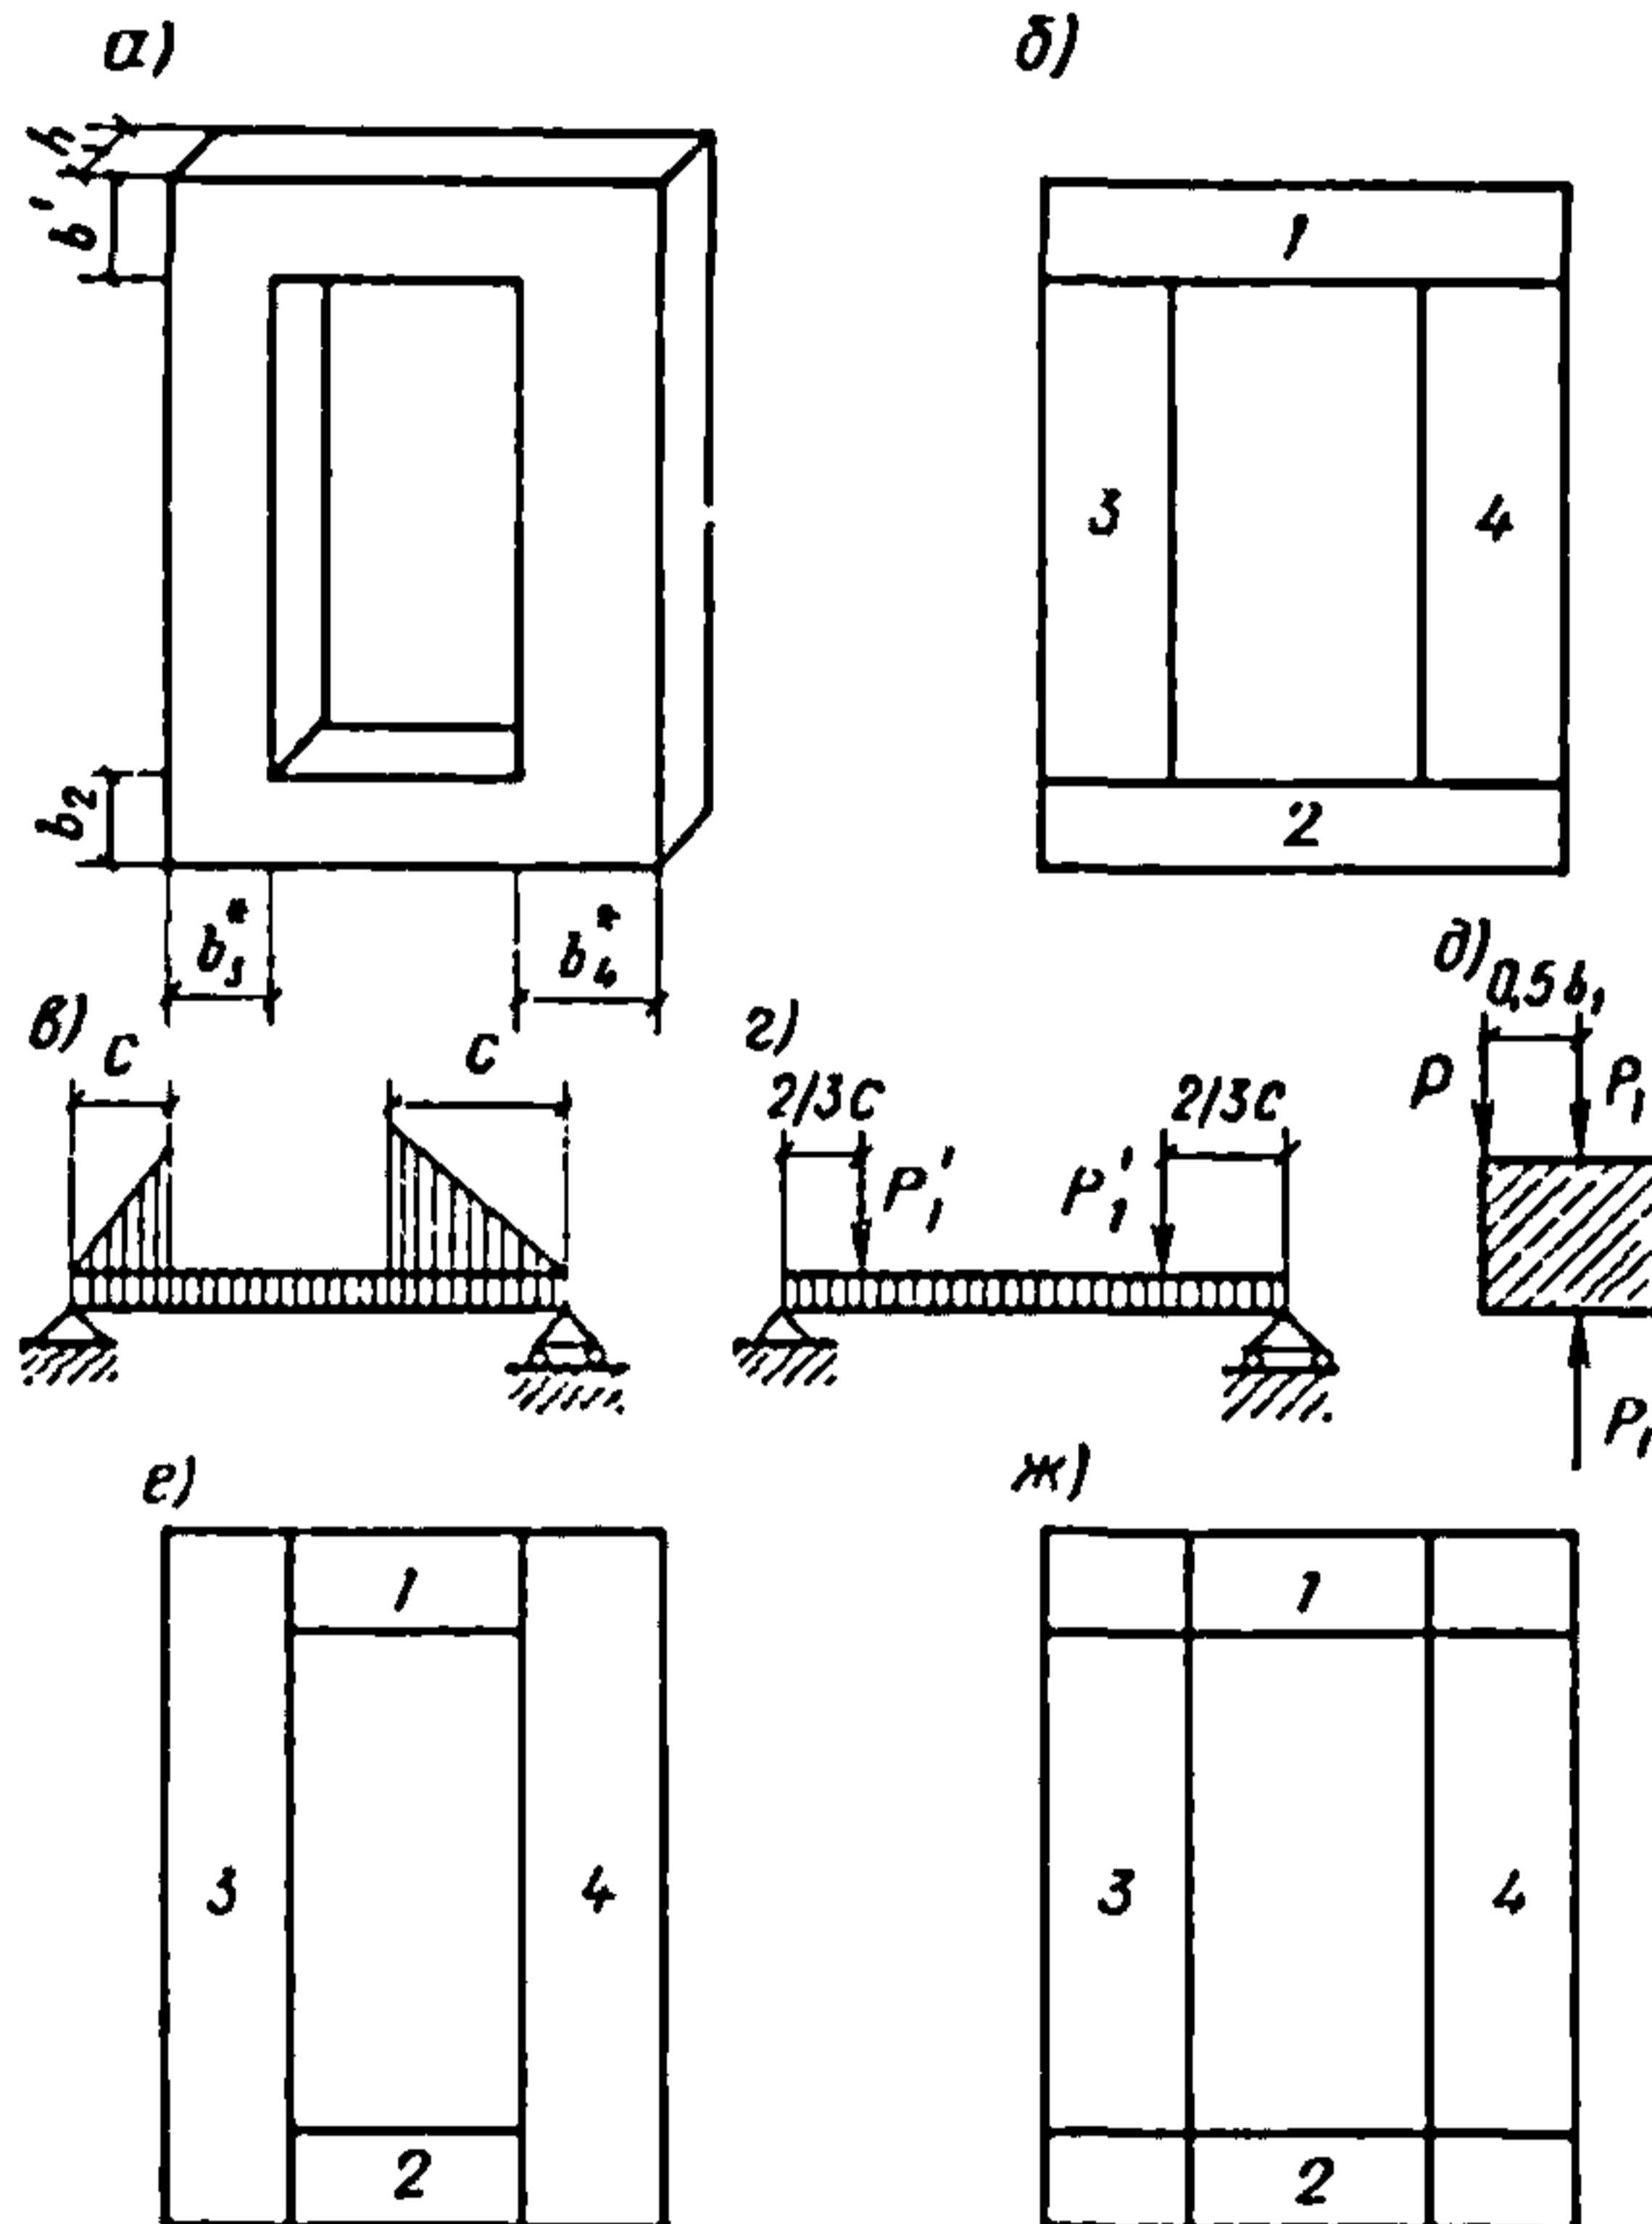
Расчетные схемы железобетонного блока с дверным проемом
